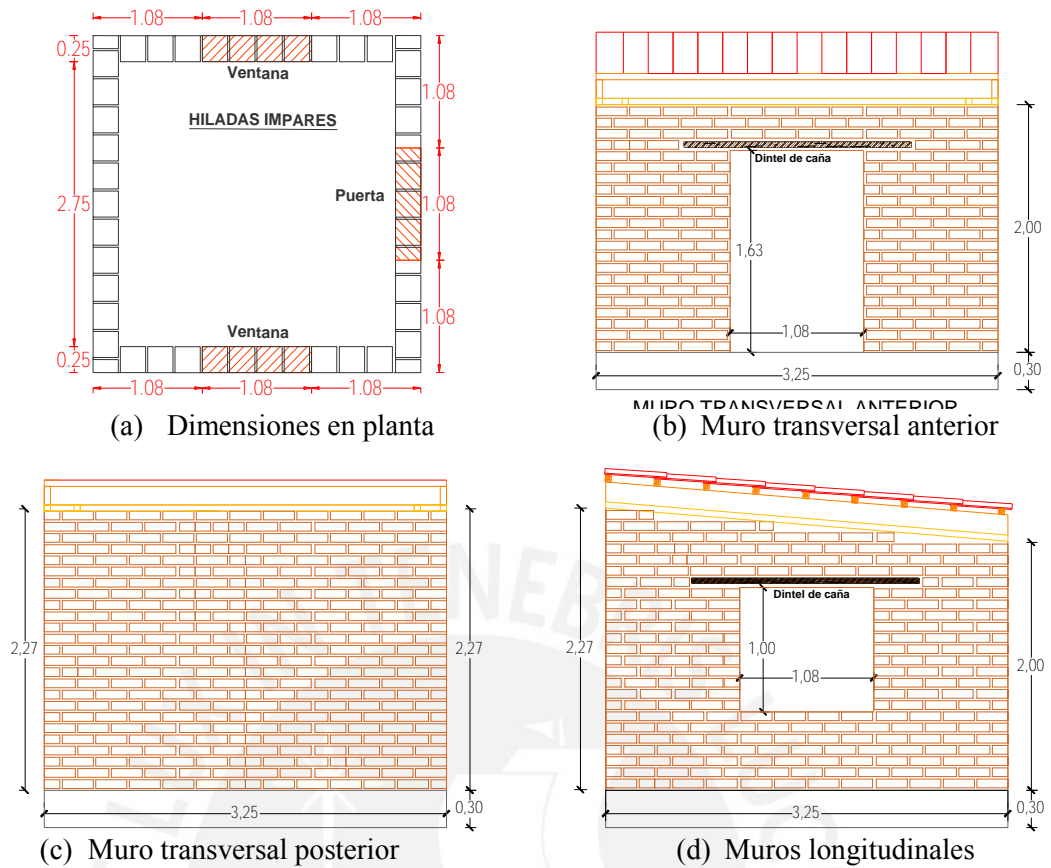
Vista en planta y elevación real del modelo de adobe
